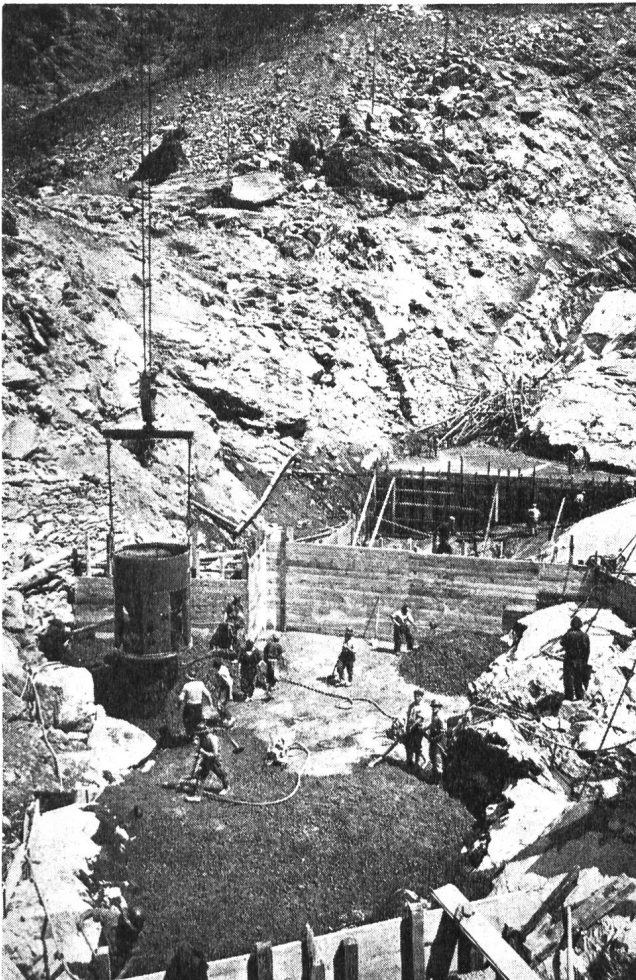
(oben) Erste Betonblöcke und Fundament linke Flanke
